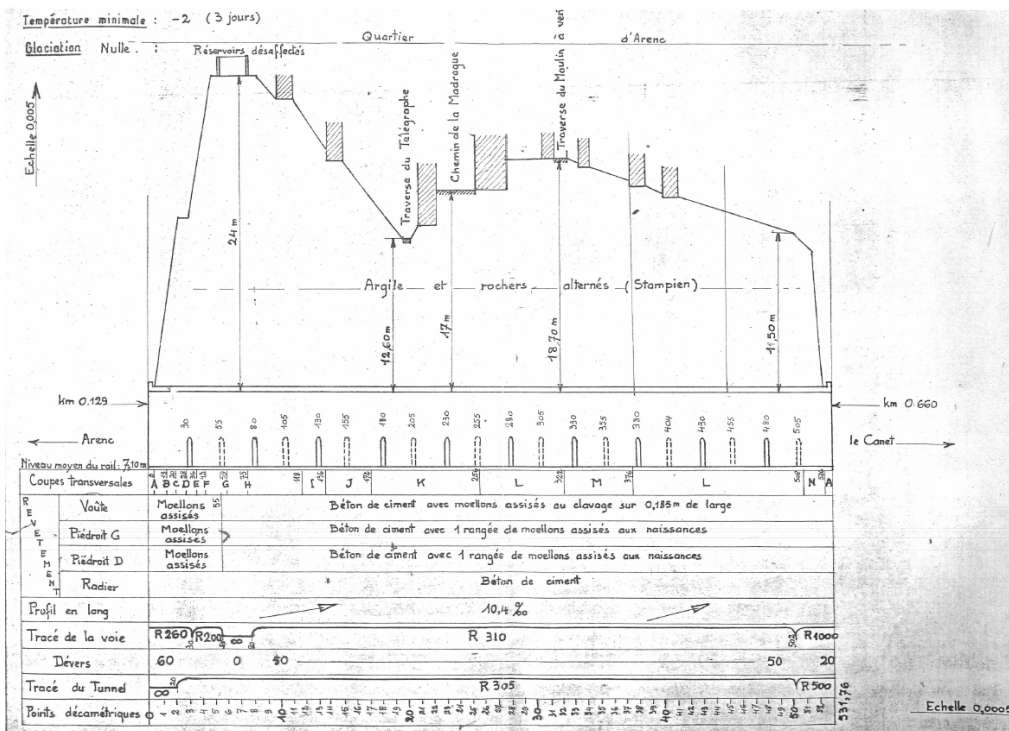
Profil en long du tunnel d'Arenc (source RFF, m.à.j. 1987)
